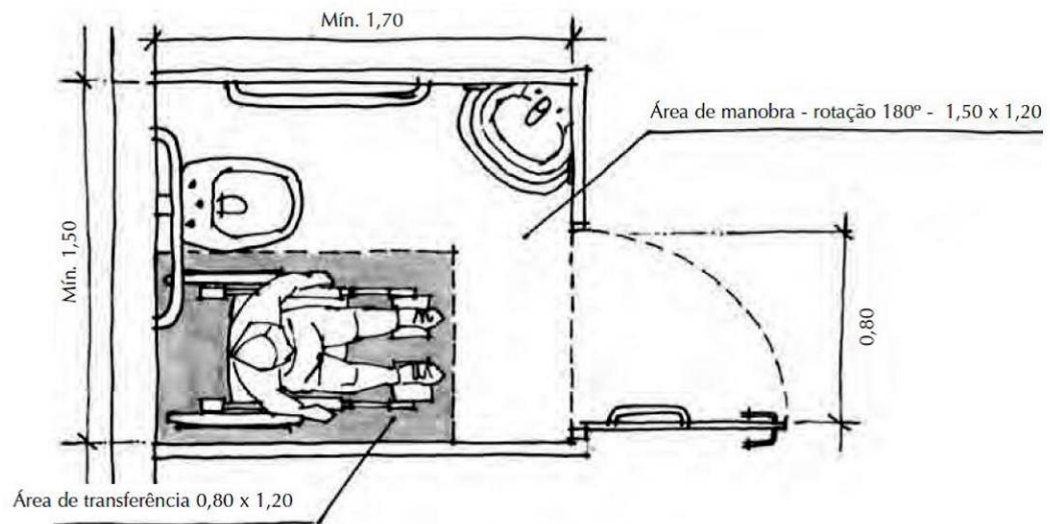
Transferência lateral em boxe para bacia sanitária (SMPED, 2008).
